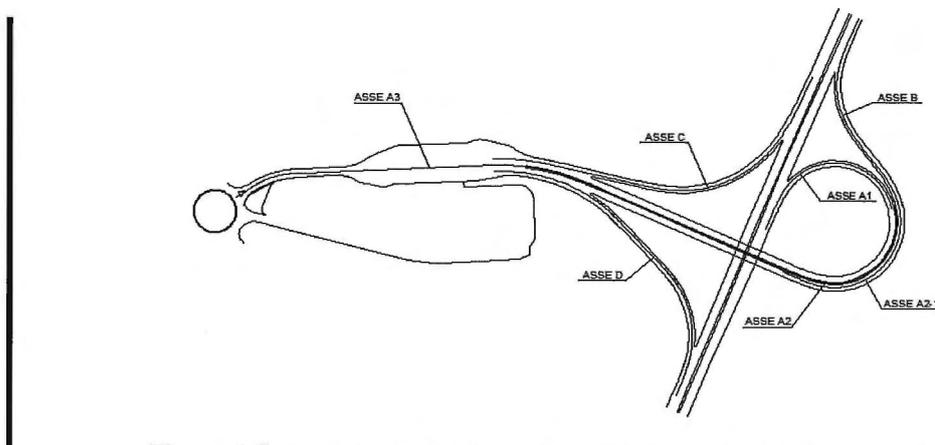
Schema Svincolo Trecasali – Terre Verdiane con identificazione rami
